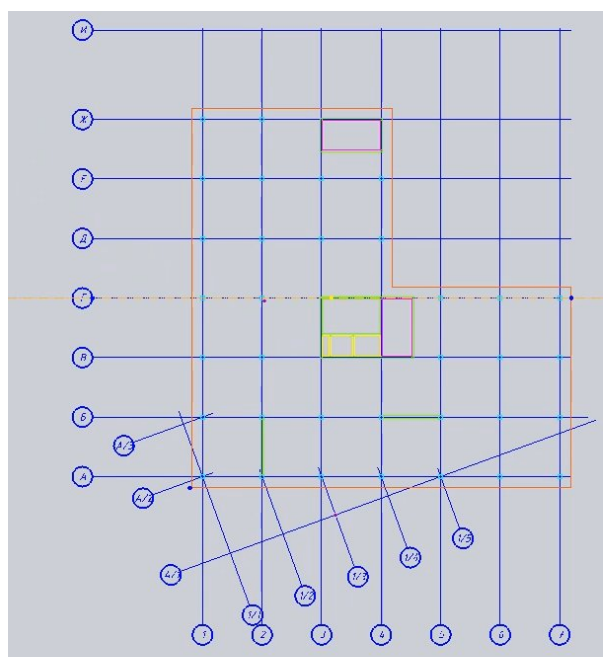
Побудова координатних осей розрахункової моделі будівлі
